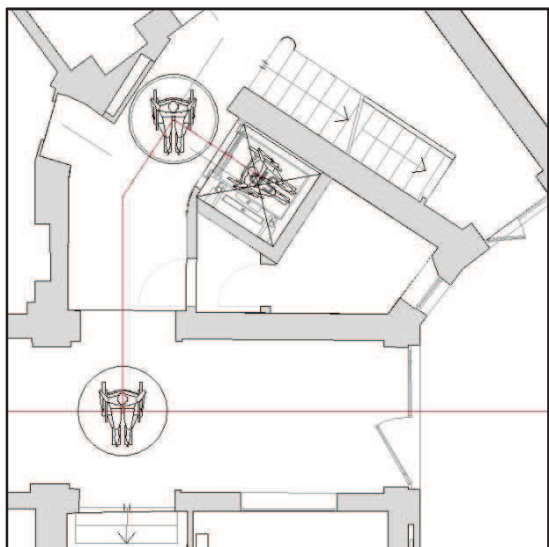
PARTICOLARE PIANTA ACCESSIBILITA' vano ascensore scala A
